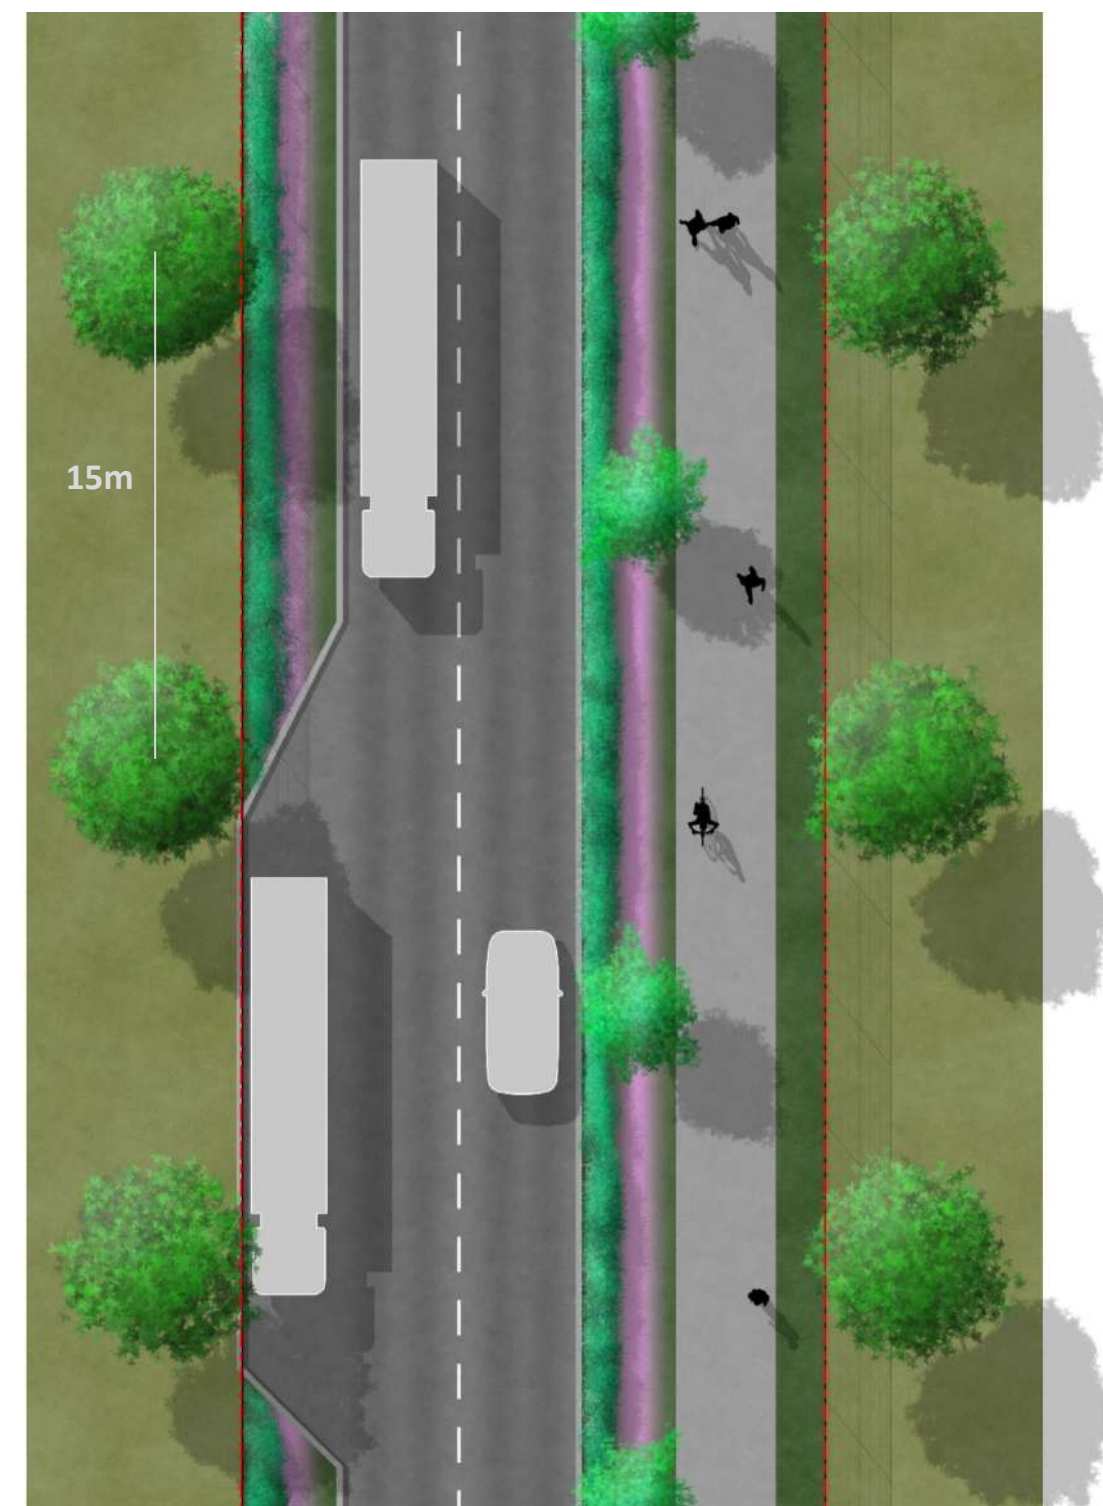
Plan de la voie de desserte de 7m sur emprise public de 17.50m
